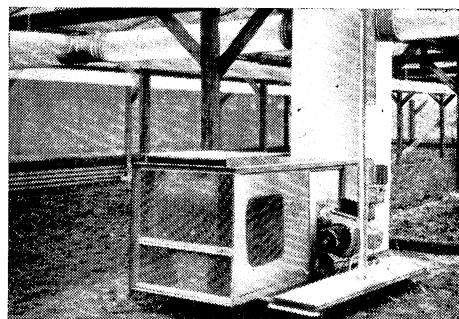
Perforované potrubí volně zavěšené. V pozadí snímku je vidět teplovzdušnou olejem vytápěnou jednotku s hlavním plechovým potrubím.
